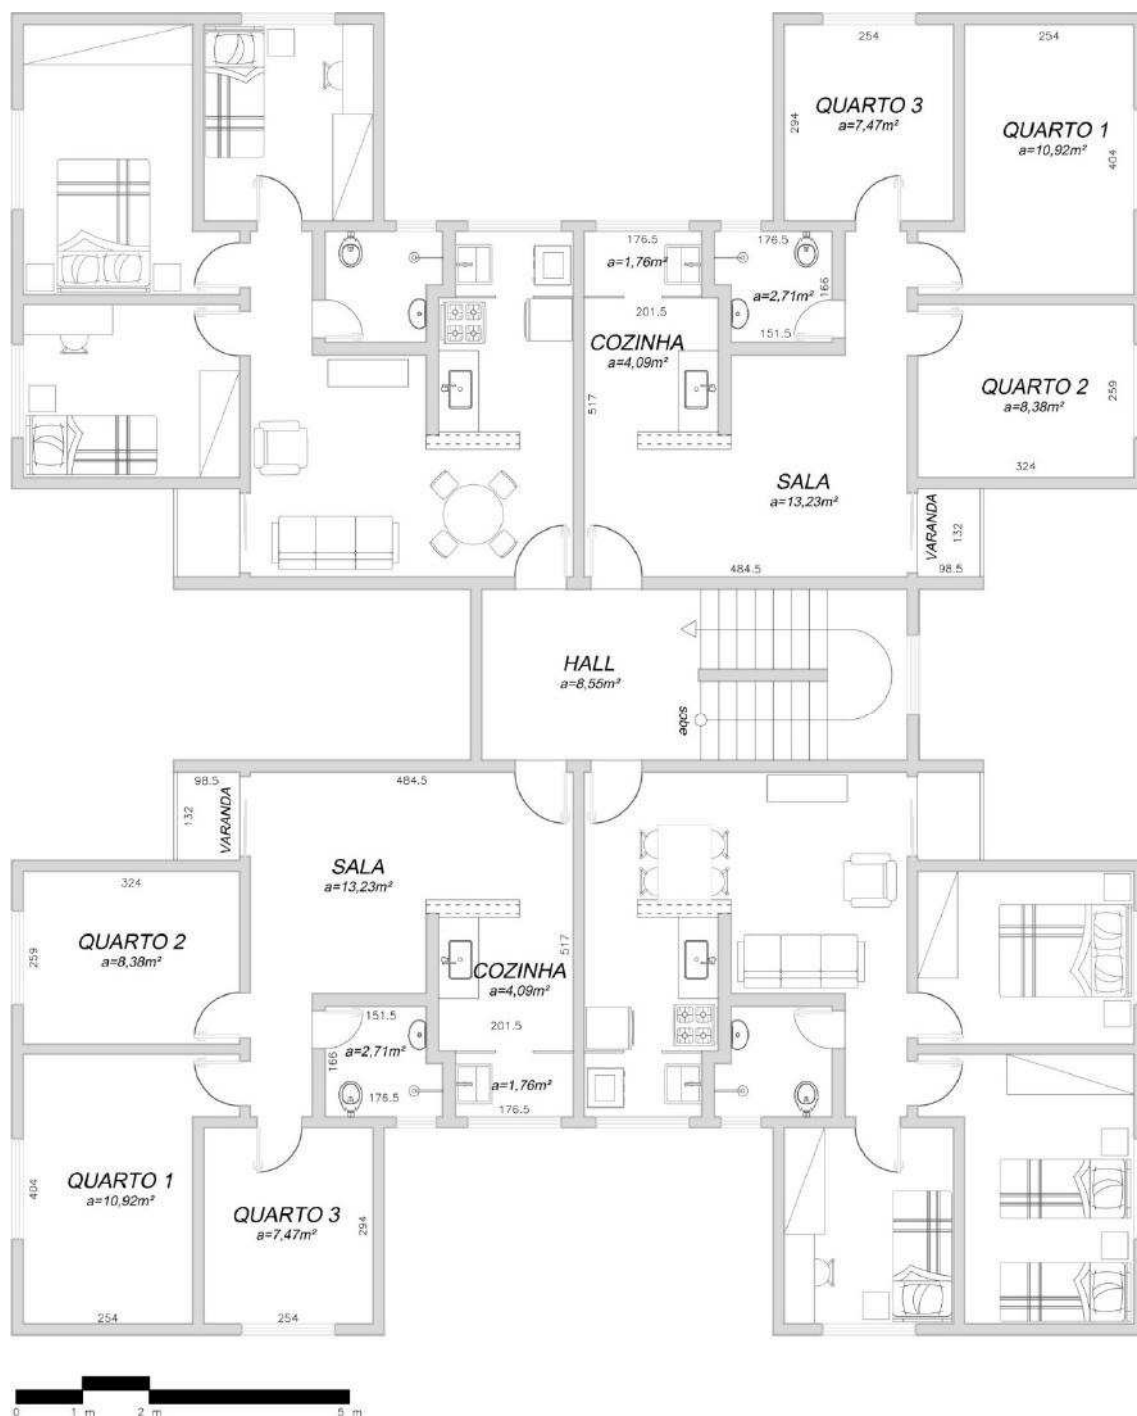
Planta do pavimento tipo (com propostas de layout) com quatro apartamentos do Residencial Embaúba.
